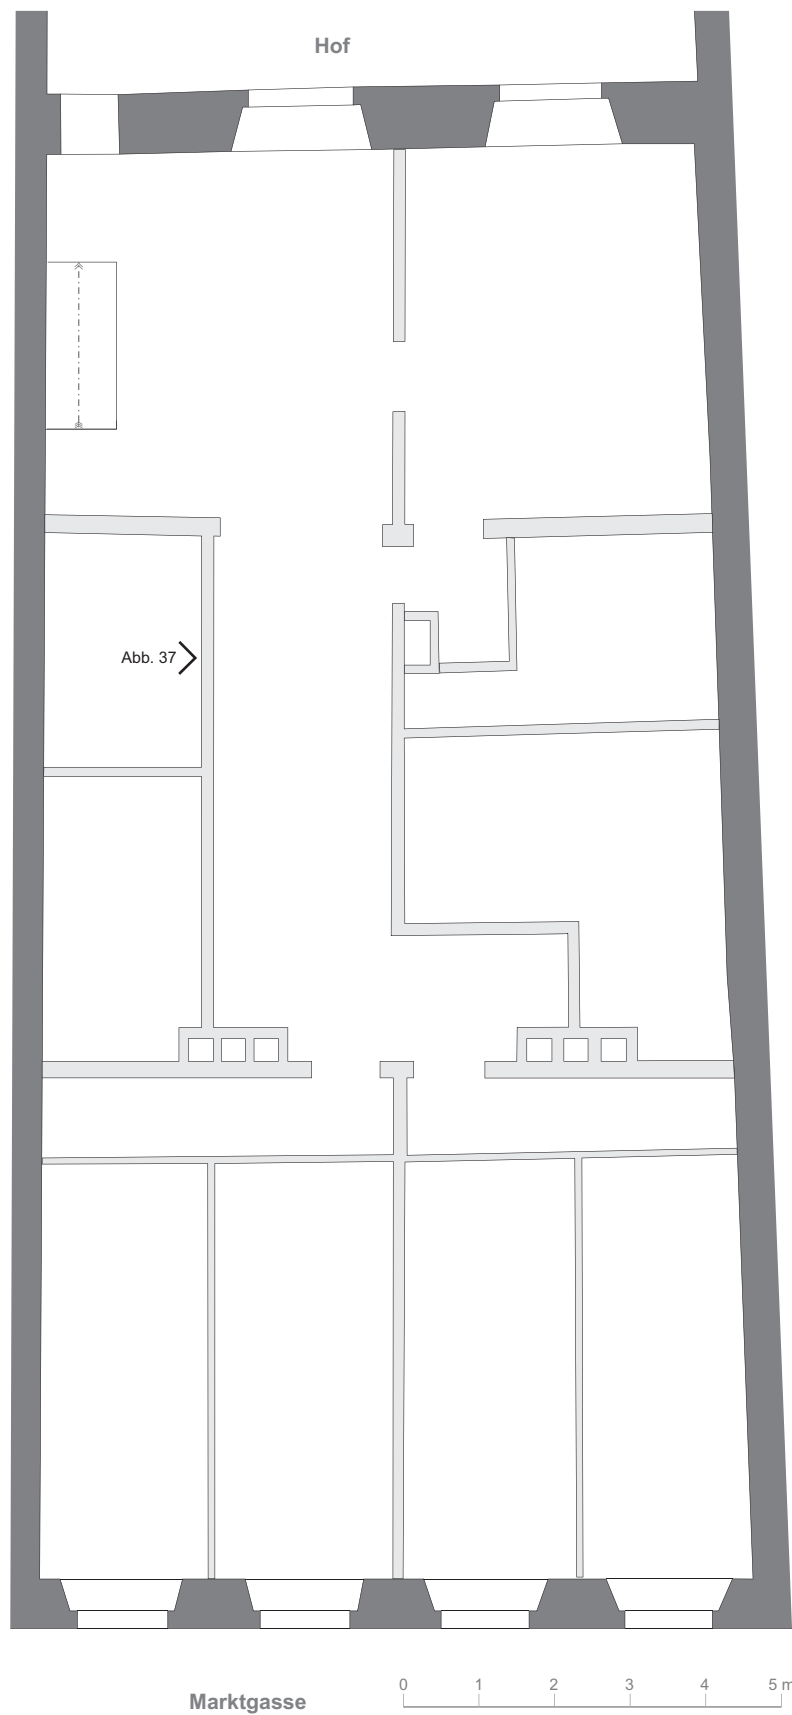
Winterthur. Marktgasse 44. Grundriss 3. Obergeschoss mit Graueintrag der jüngsten Binnenwände. M. 1:100.
